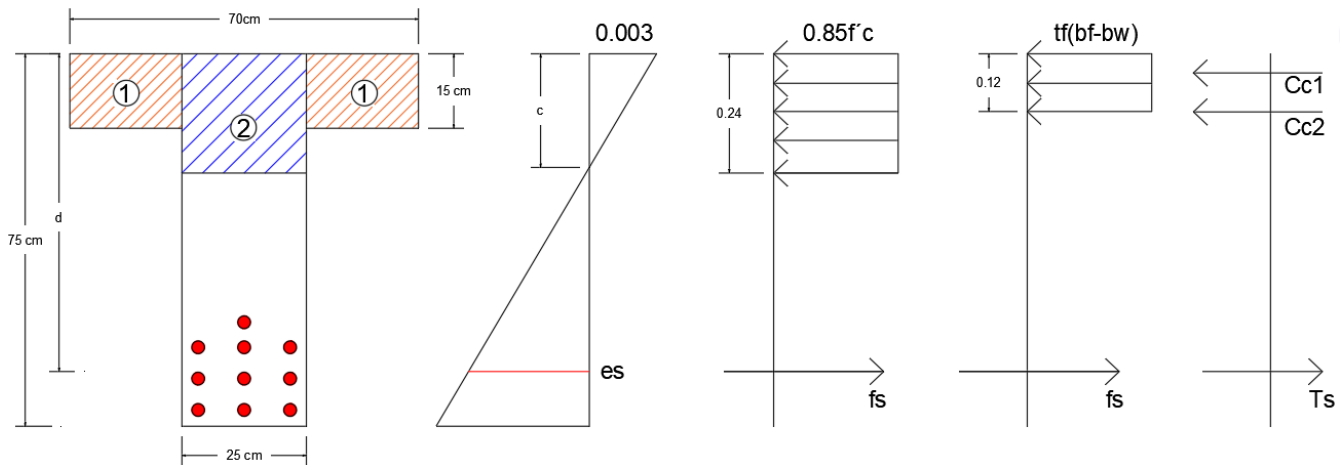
Detalle esfuerzos y deformaciones, viga T.
